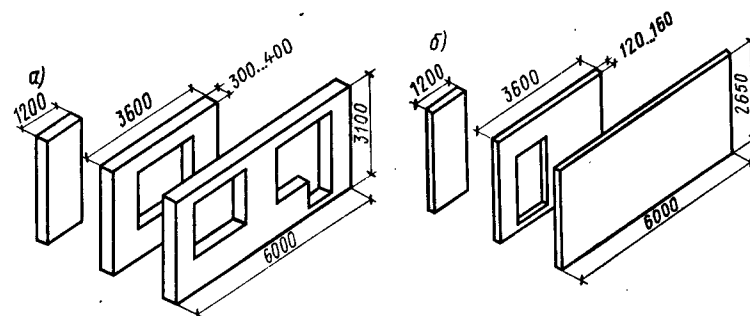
Панели наружных (а) и внутренних (б) стен жилых зданий
